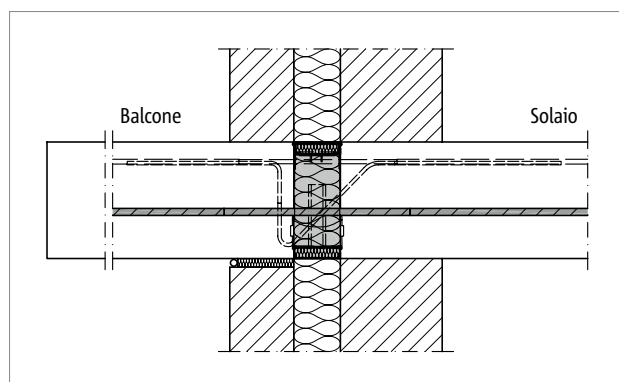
Schöck Isokorb® T tipo KL, HP-NN: muratura bistrato con interposto isolamento
